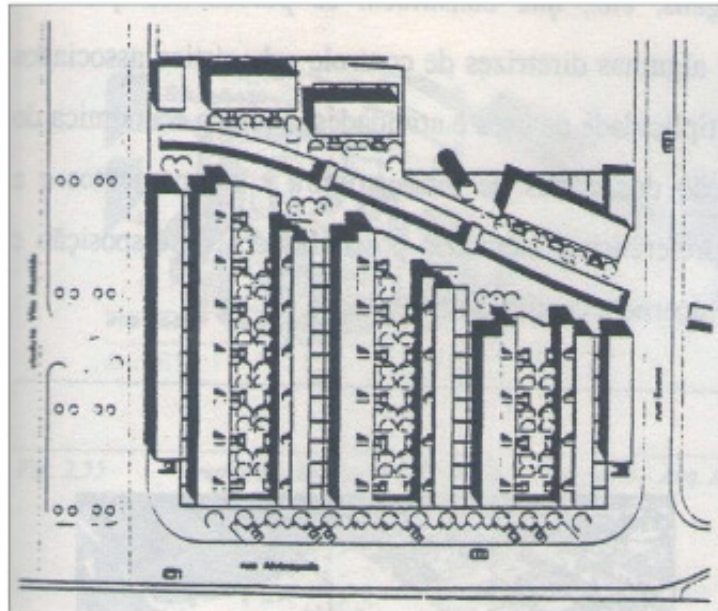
Implantação Conj. Habitacional de Rincão – São Paulo – Arq. Padovano/Viglicca
